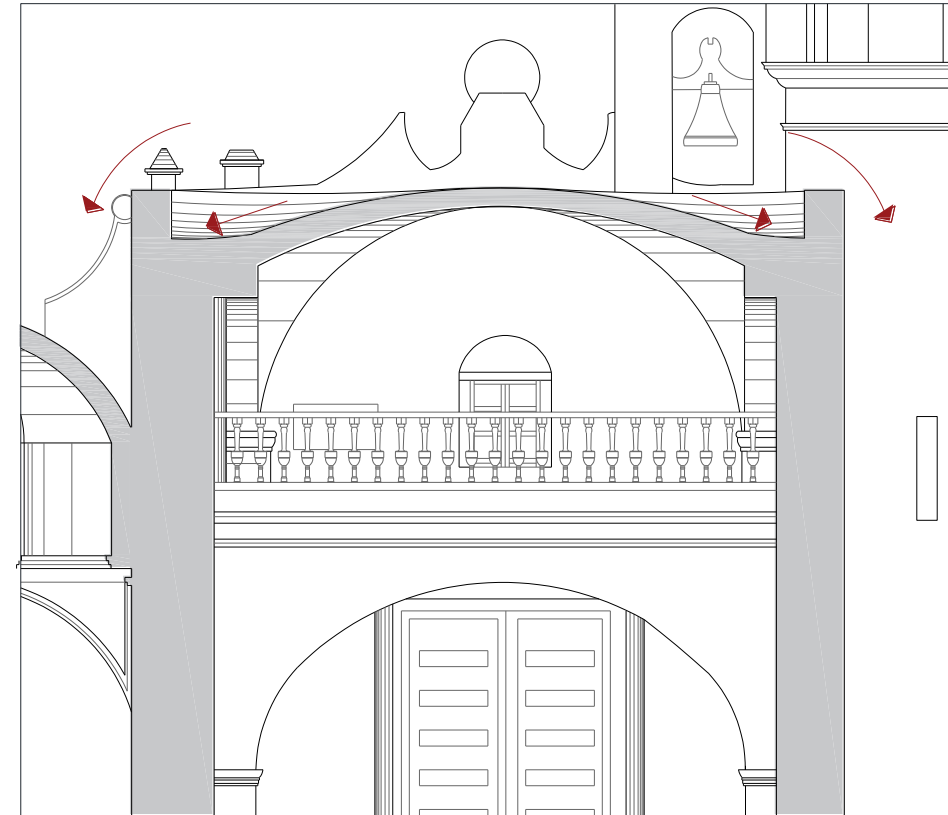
Las cargas de la cubierta abovedada generan empujes horizontales sobre los muros, que de no tener refuerzos provocaría el volteo
